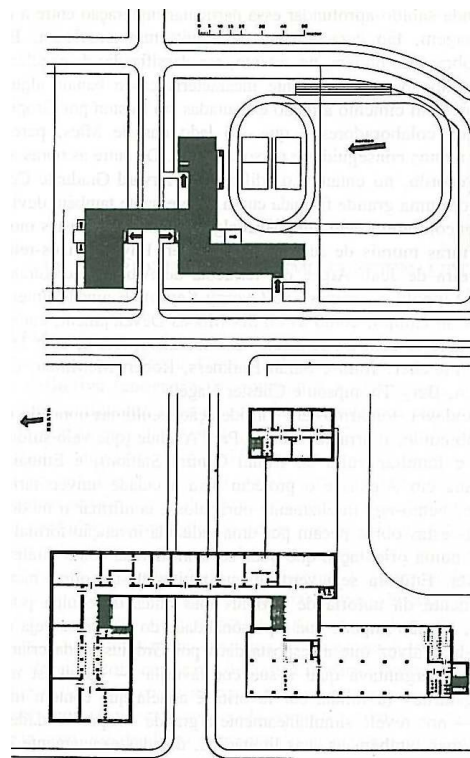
Planimetria e planta do piso térreo da Bauhaus, Dessau.
